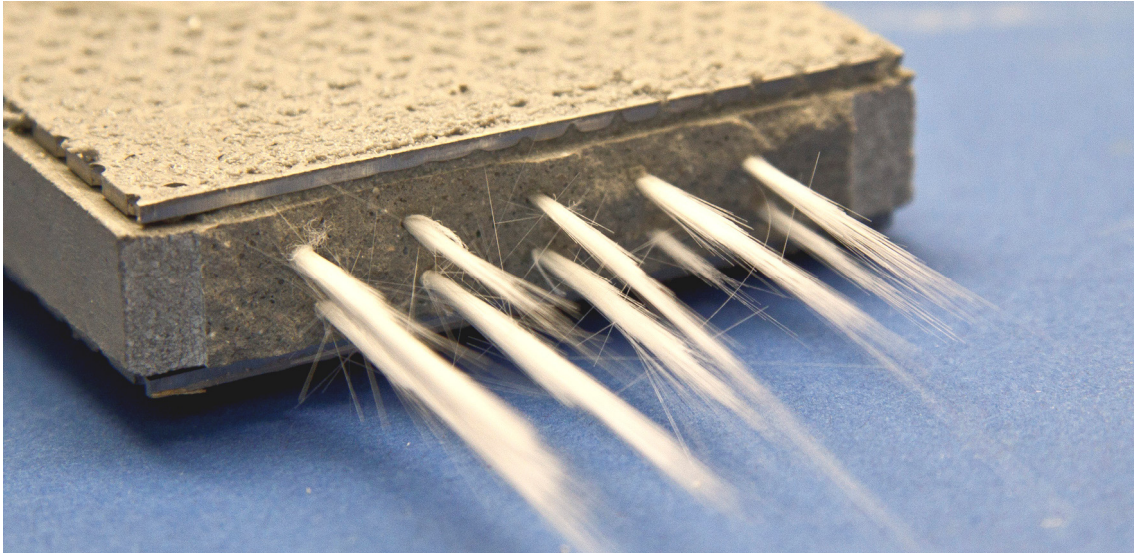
Bruchfläche eines Dehnkörpers mit Textilbewehrung nach dem Rissöffnungsversuch
